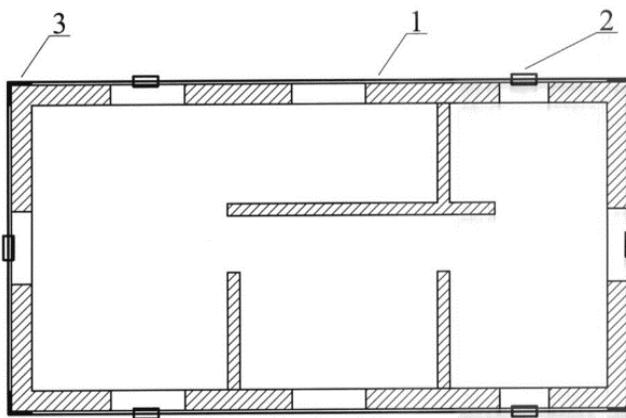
Восстановление пространственной жесткости (устойчивости) здания стальными поясами, расположенными в уровне перекрытий:
